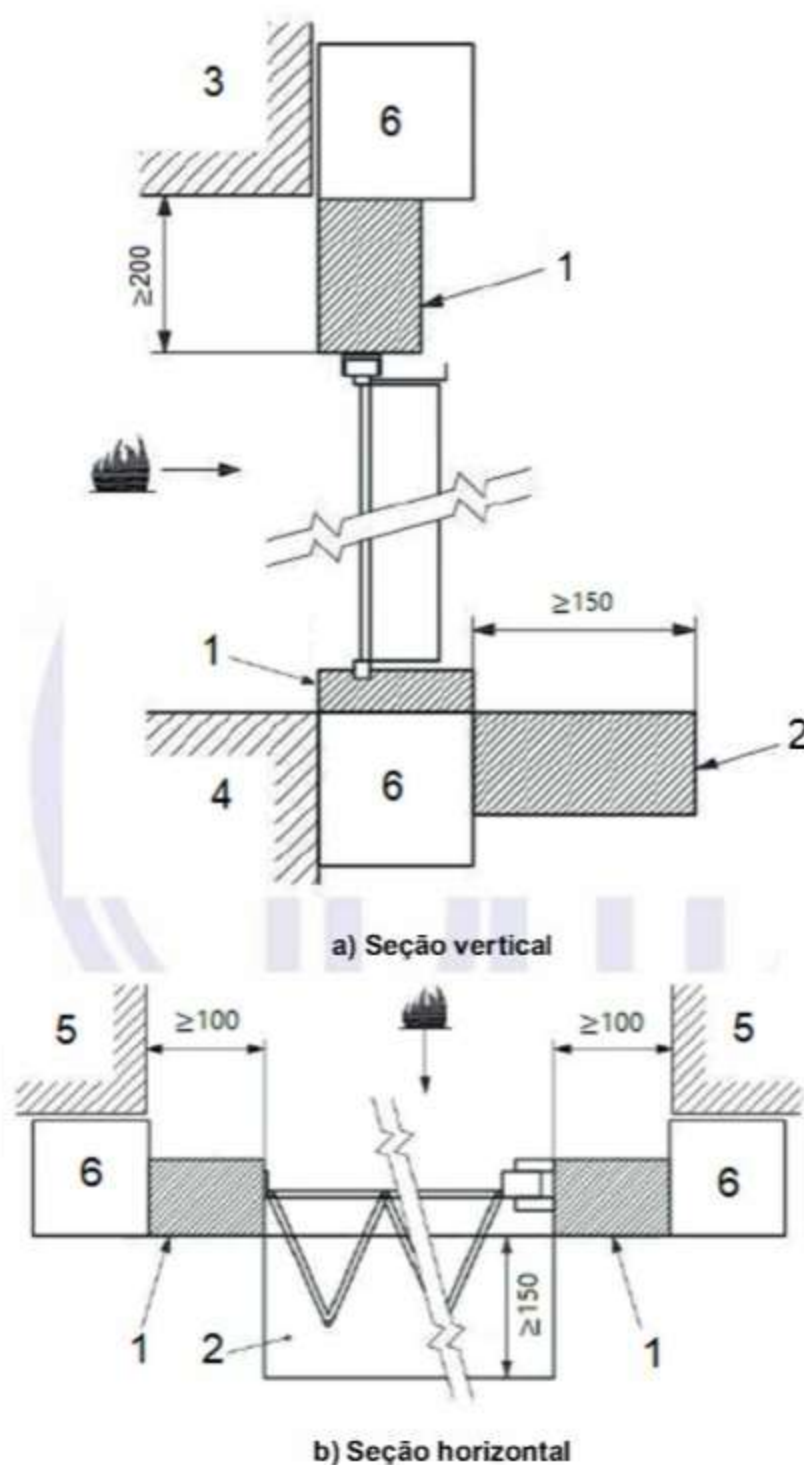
Exemplo de montagem de portas com tipologia de giro para ensaio – Seção vertical
